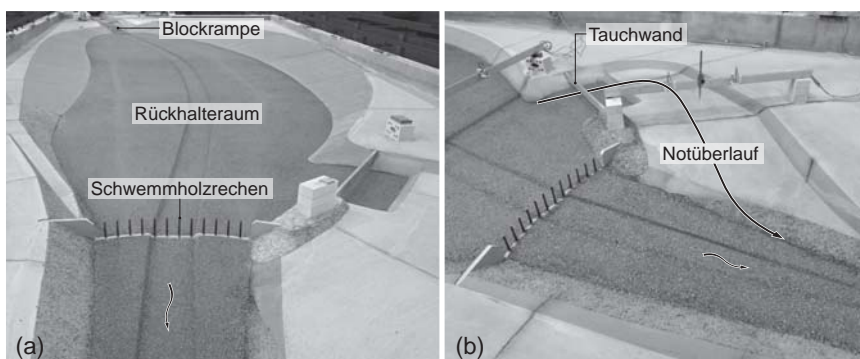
(a) Hydraulisches Modell des Geschiebesammlers, (b) Detail Schwemmholzrechen und Notüberlaufstrecke mit Tauchwand.
